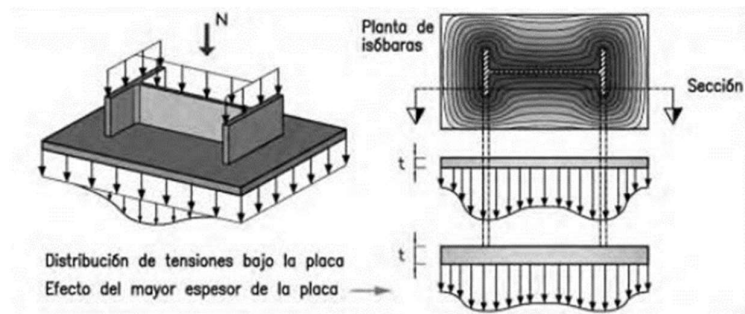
| Distribución de tensiones bajo la placa. Fuente: Instrucción de Acero Estructural (EAE).
